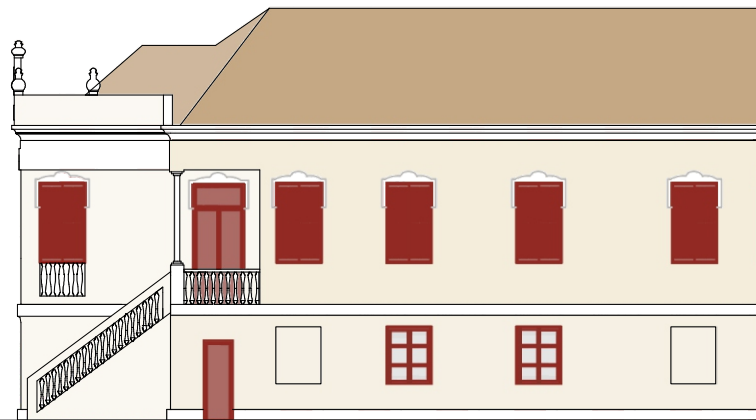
LEVANTAMENTO FACHADAS. Fonte: Acervo pessoal.
